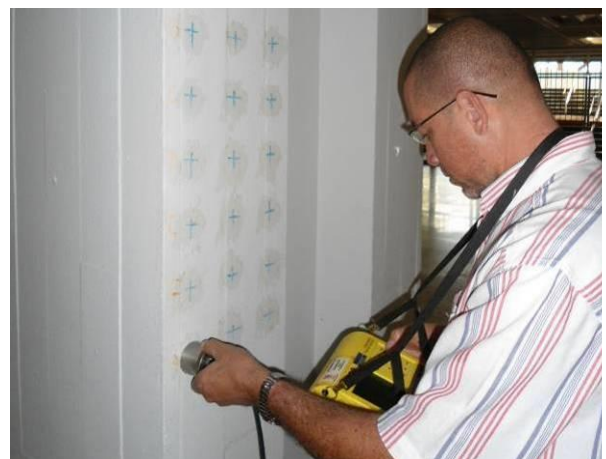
Detalhe da realização do ensaio de ultrassom no pilar P12D.
